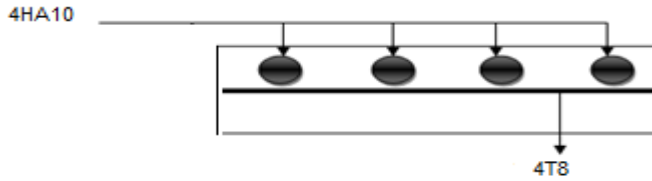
Schéma de ferrailage de la dalle pleine sur 2 appuis
